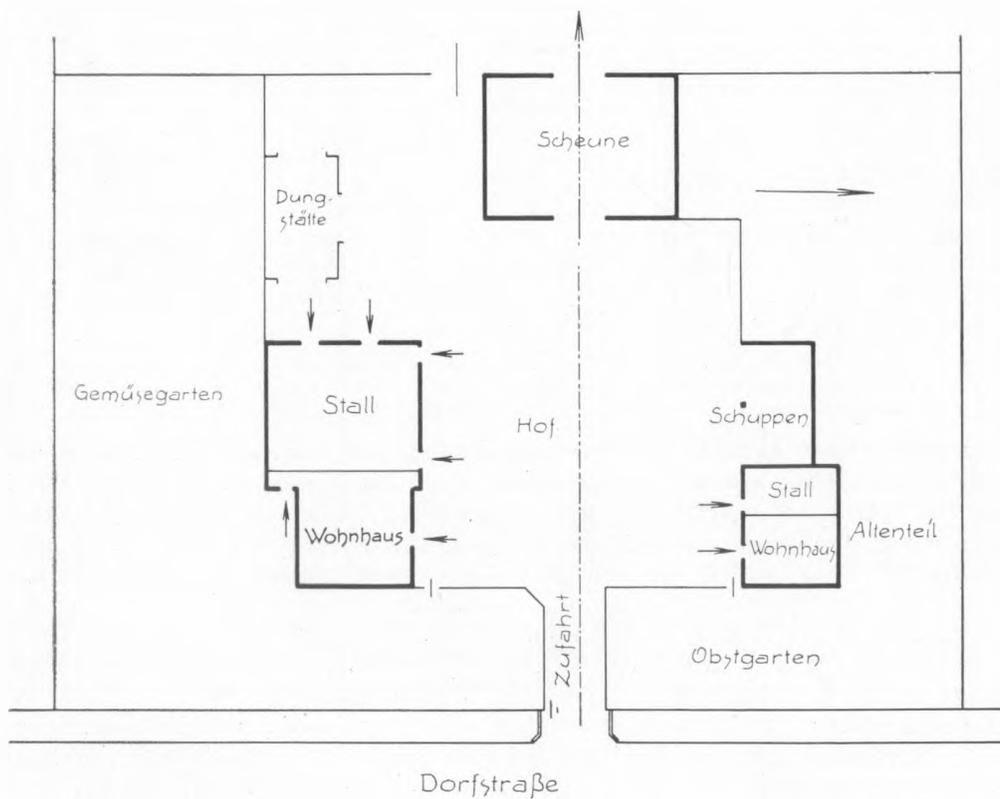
Dreiseitig geschlossene Hoflage. Zusammenbau von Wohnhaus und Stall unter einem Dach. Düngerstätte auf dem Nebenhof.
